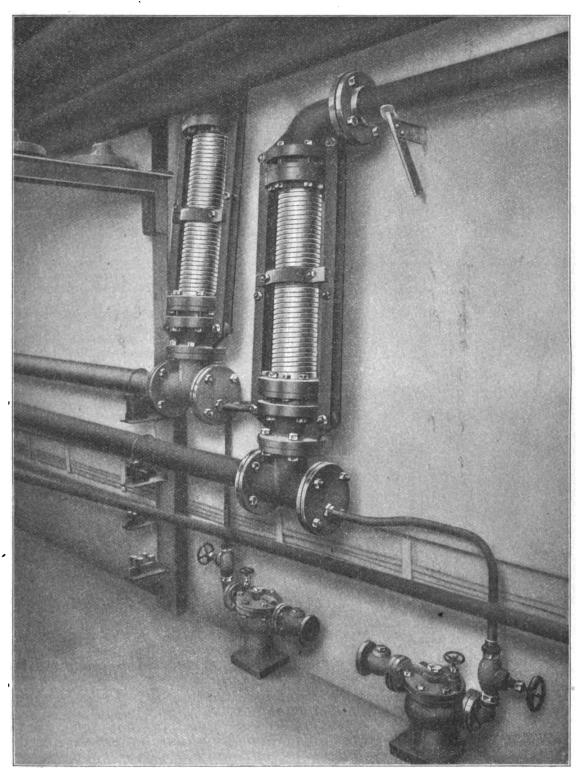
Wärmeausgleicher aus geschweißtem Metallschlauch für Dampfhochdruckleitungen, eingebaut im Krankenhaus St. Georg in Leipzig.
